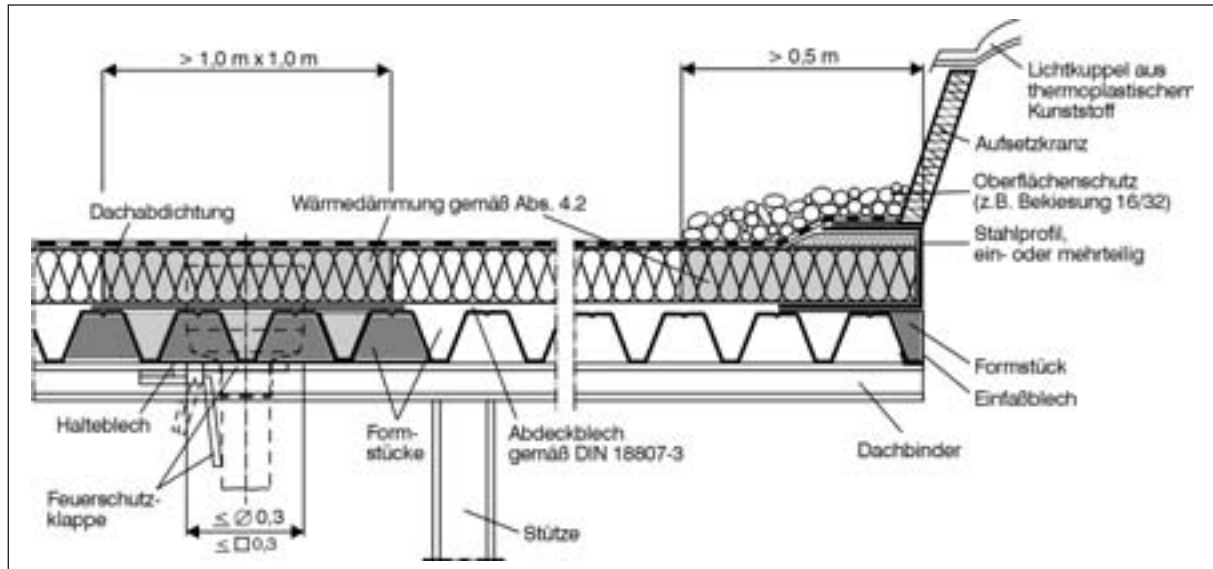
Ausführungsbeispiel für kleinere Dachdurchdringungen mit selbstschließendem Schutzsystem und für größere Dachdurchdringungen
